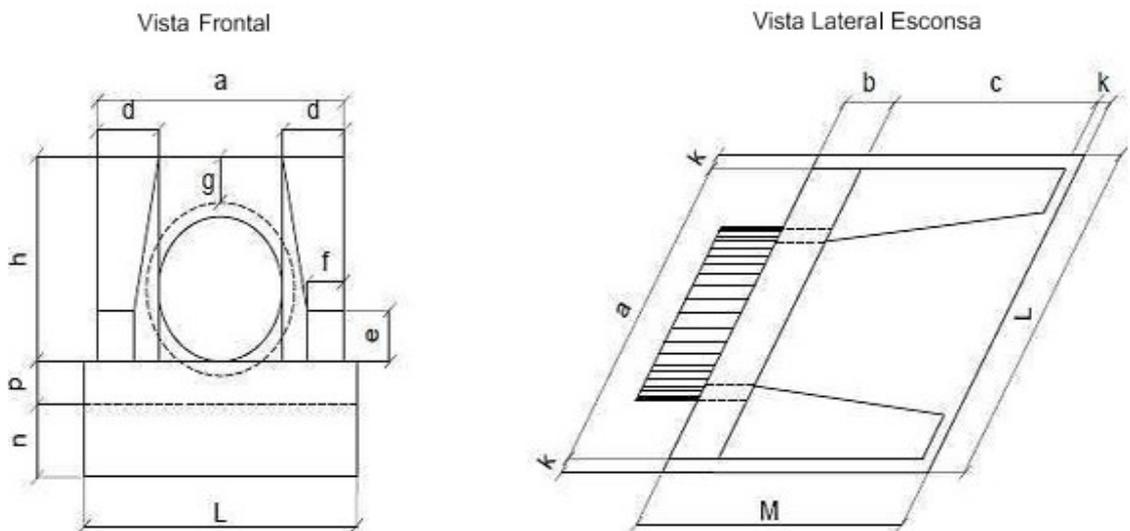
Vistas frontal e lateral, com detalhe esconso, da boca de bueiro simples tubular
